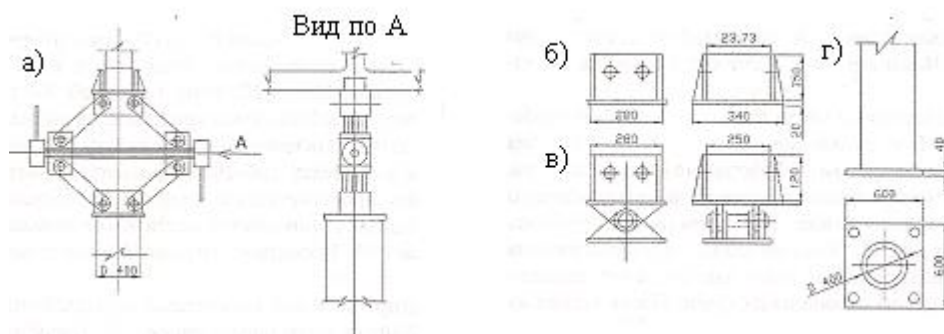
Основные узлы временной опоры а) схема подъемного устройства; б) оголовок для вертикальной опоры; в) оголовок для наклонной опоры и подкоса; г) пята опоры
